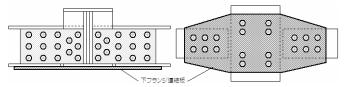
浜田川橋りょうの下フランジ連結工法(側面図と下フランジ連結板平面図)
